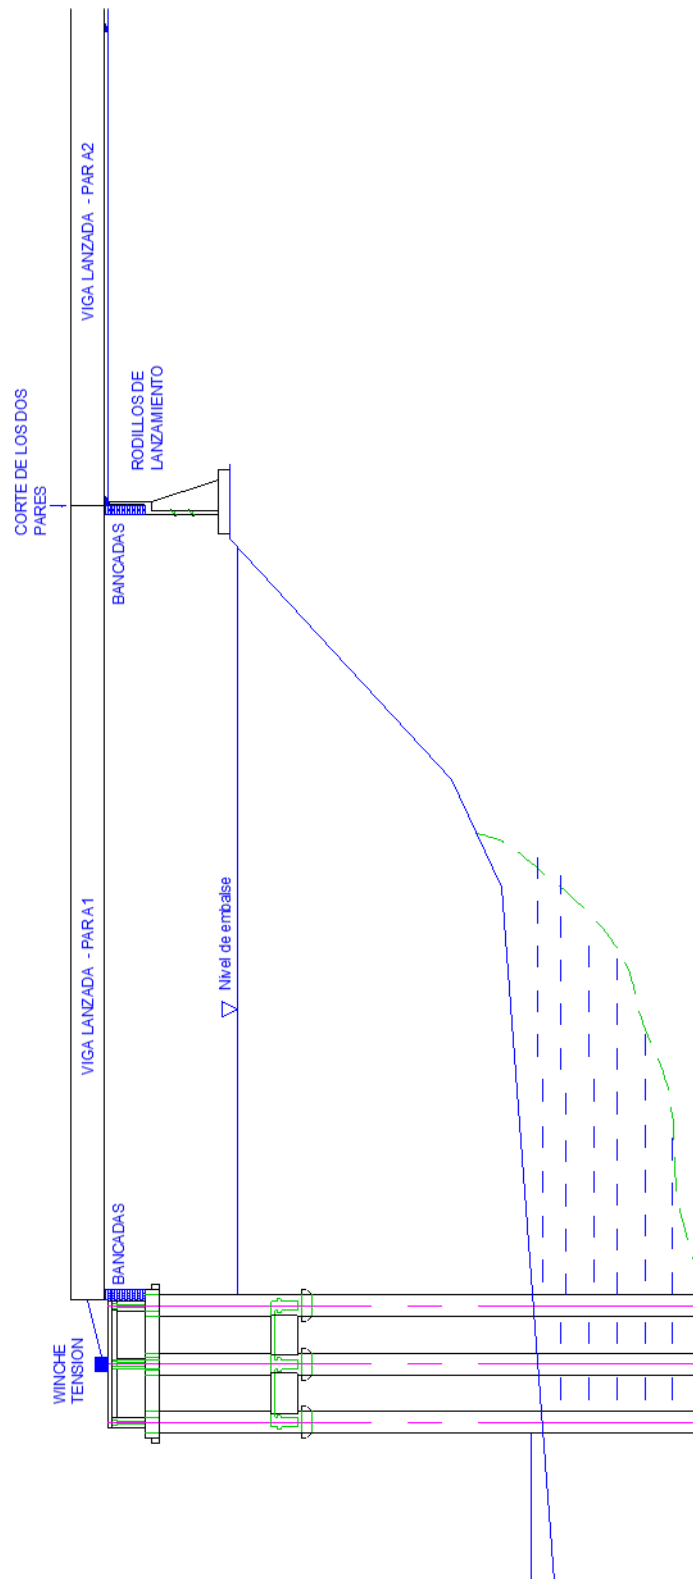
Retiro de la celosía metálica para poder distensionar las dos secciones del par de vigas
